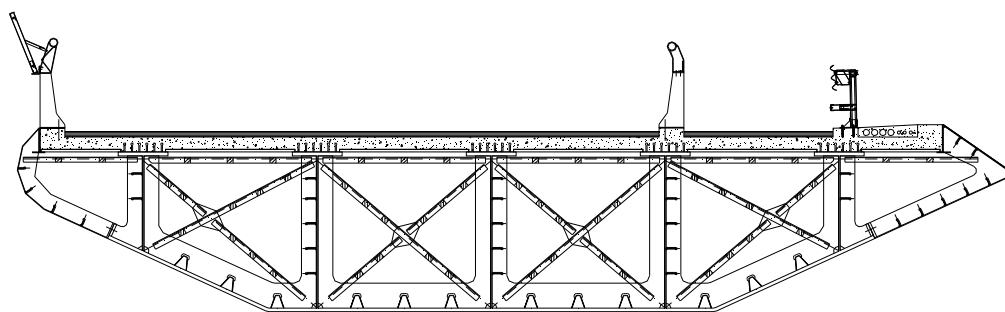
Progetto Preliminare - sezione trasversale dell'impalcato stradale
